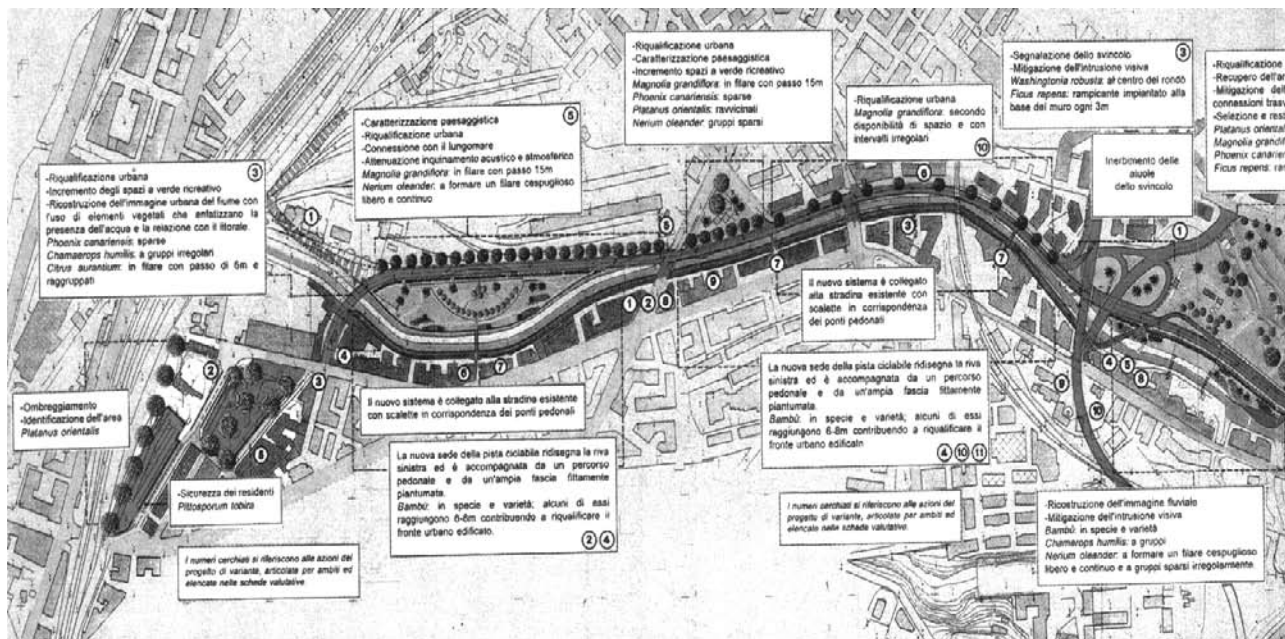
Il progetto dell'asse Irno a Salerno. Stralcio della planimetria generale.
